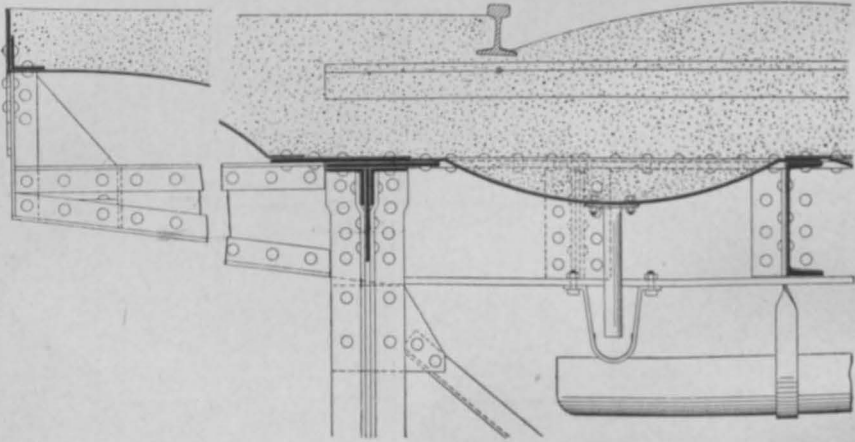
Unterführung der Luxemburgerstraße in Köln. Dichte Fahrbahntafel mit Kiesbett und Schienensträngen. 1 : 20.
